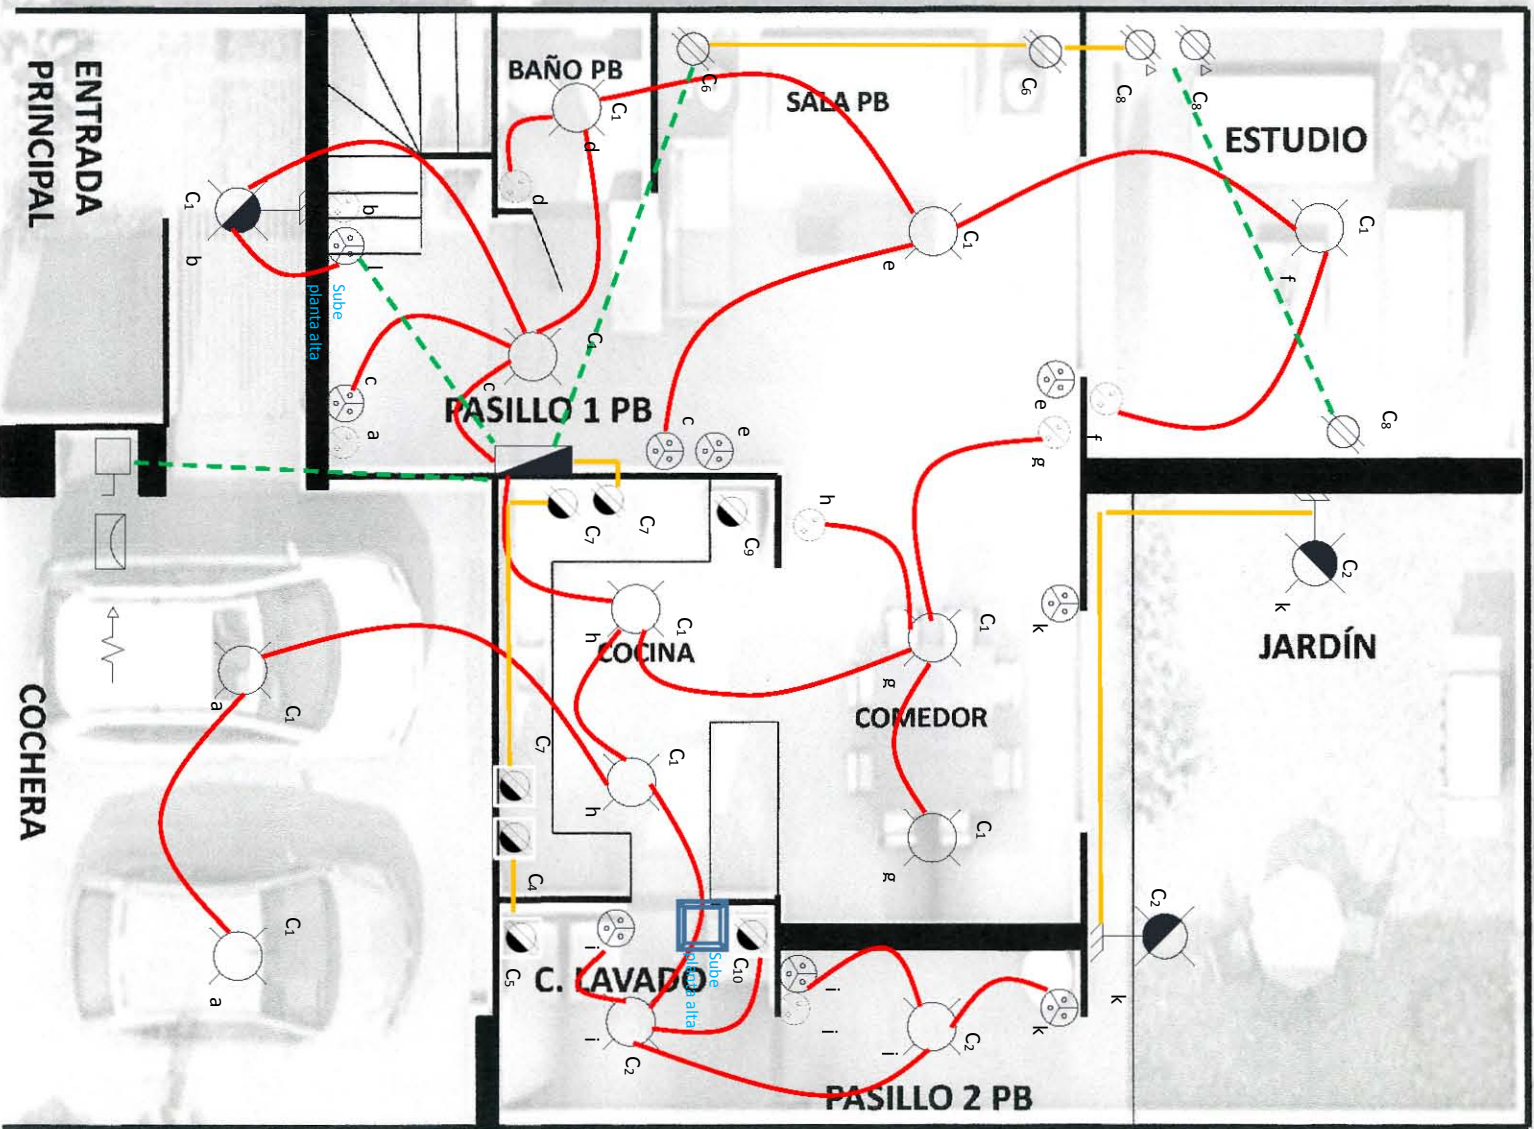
Plano de Obra Civil Planta baja con canalizaciones para los diferentes circuitos derivados.
